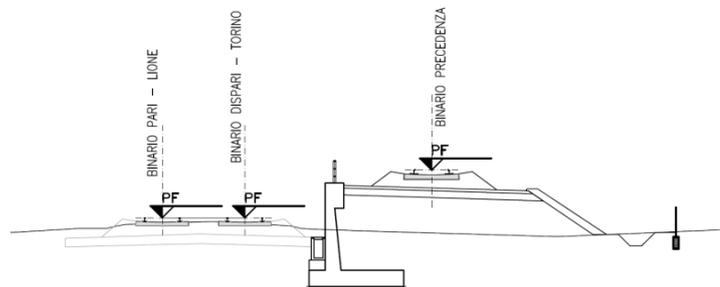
Sezione tipo configurazione in rilevato con muro di sostegno
